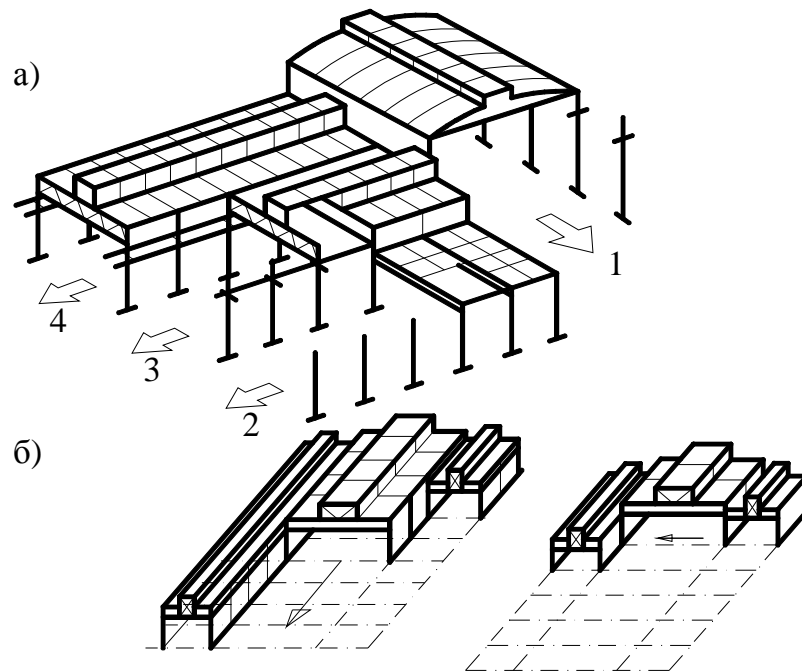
Схема монтажу одноповерхових каркасно-панельних будинків:
